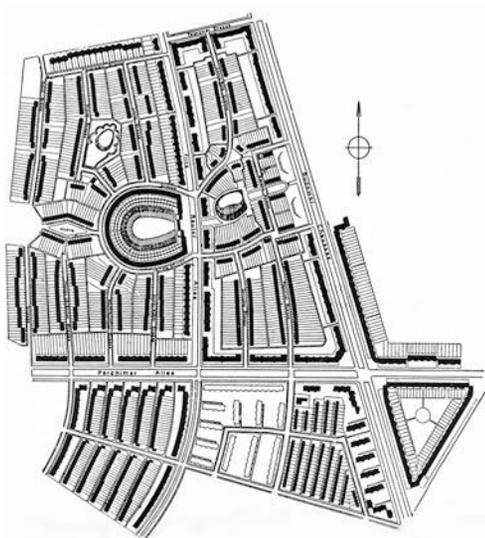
/ Plan de ordenación de la *Großsiedlung Britz
